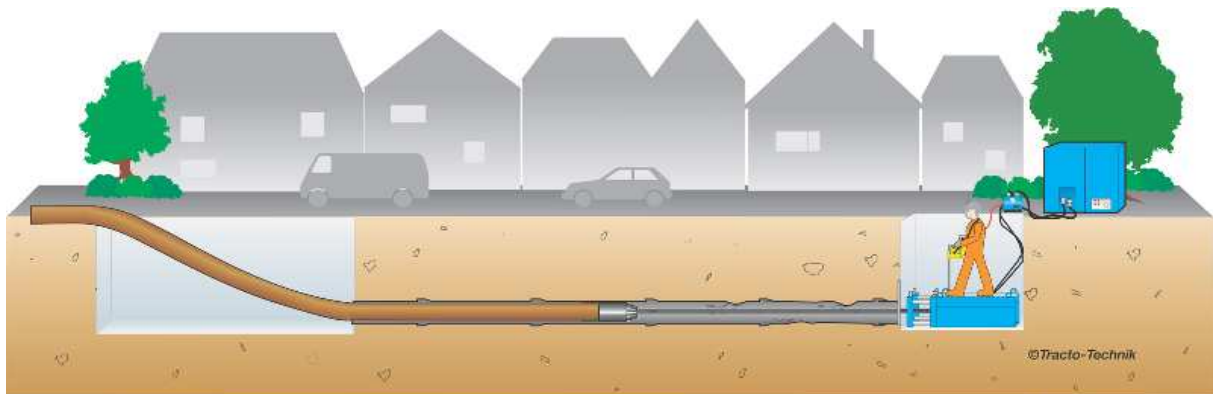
Rohrstrang- Lining ohne Ringraum von Baugrube zu Baugrube
